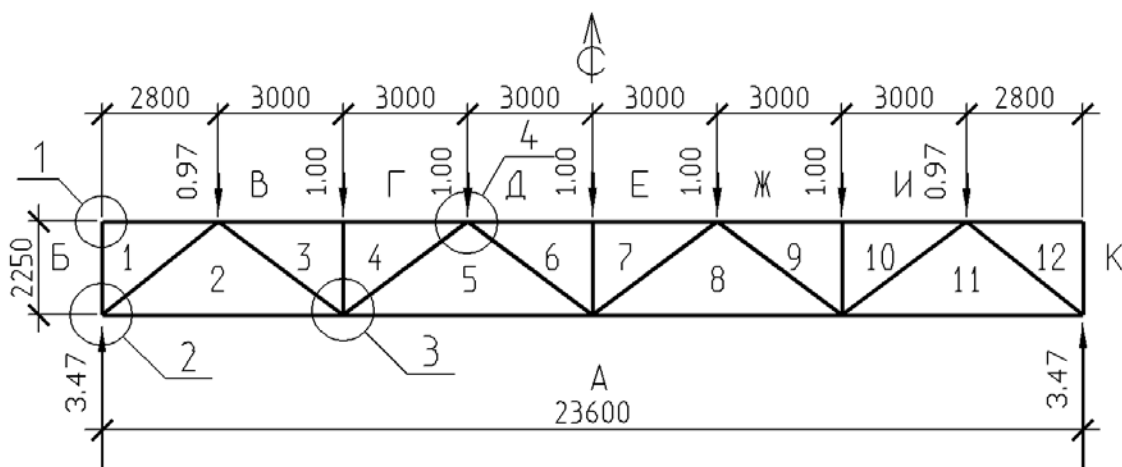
Схема фермы с внешними нагрузками, опорными реакциями и нумерацией полей.
